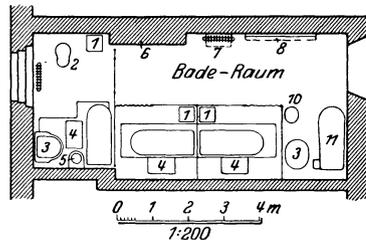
München-Schwabing. Städt. Krankenhaus. Baderaum.
